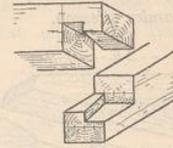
Blatt. Die hakenförmige Ecküberblattung. Der schwalbenschwanzförmige Haken macht ein Herausziehen der Hölzer nach jeder Richtung hin unmöglich.
